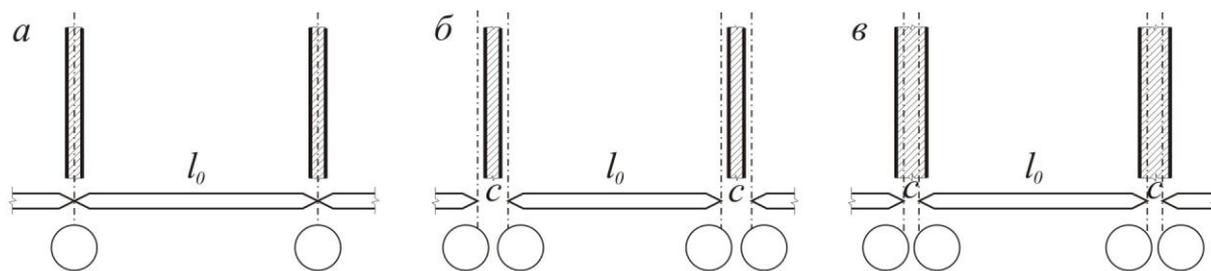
Розташування координаційних осей на плані будівель із несучими стінами [26]:
